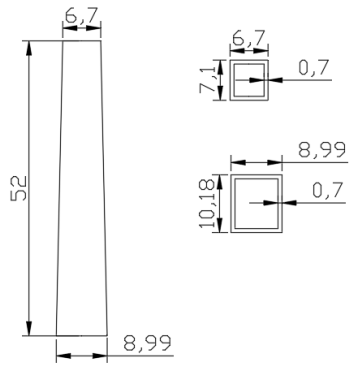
Pila 4 Perfil, Sección superior e inferior
